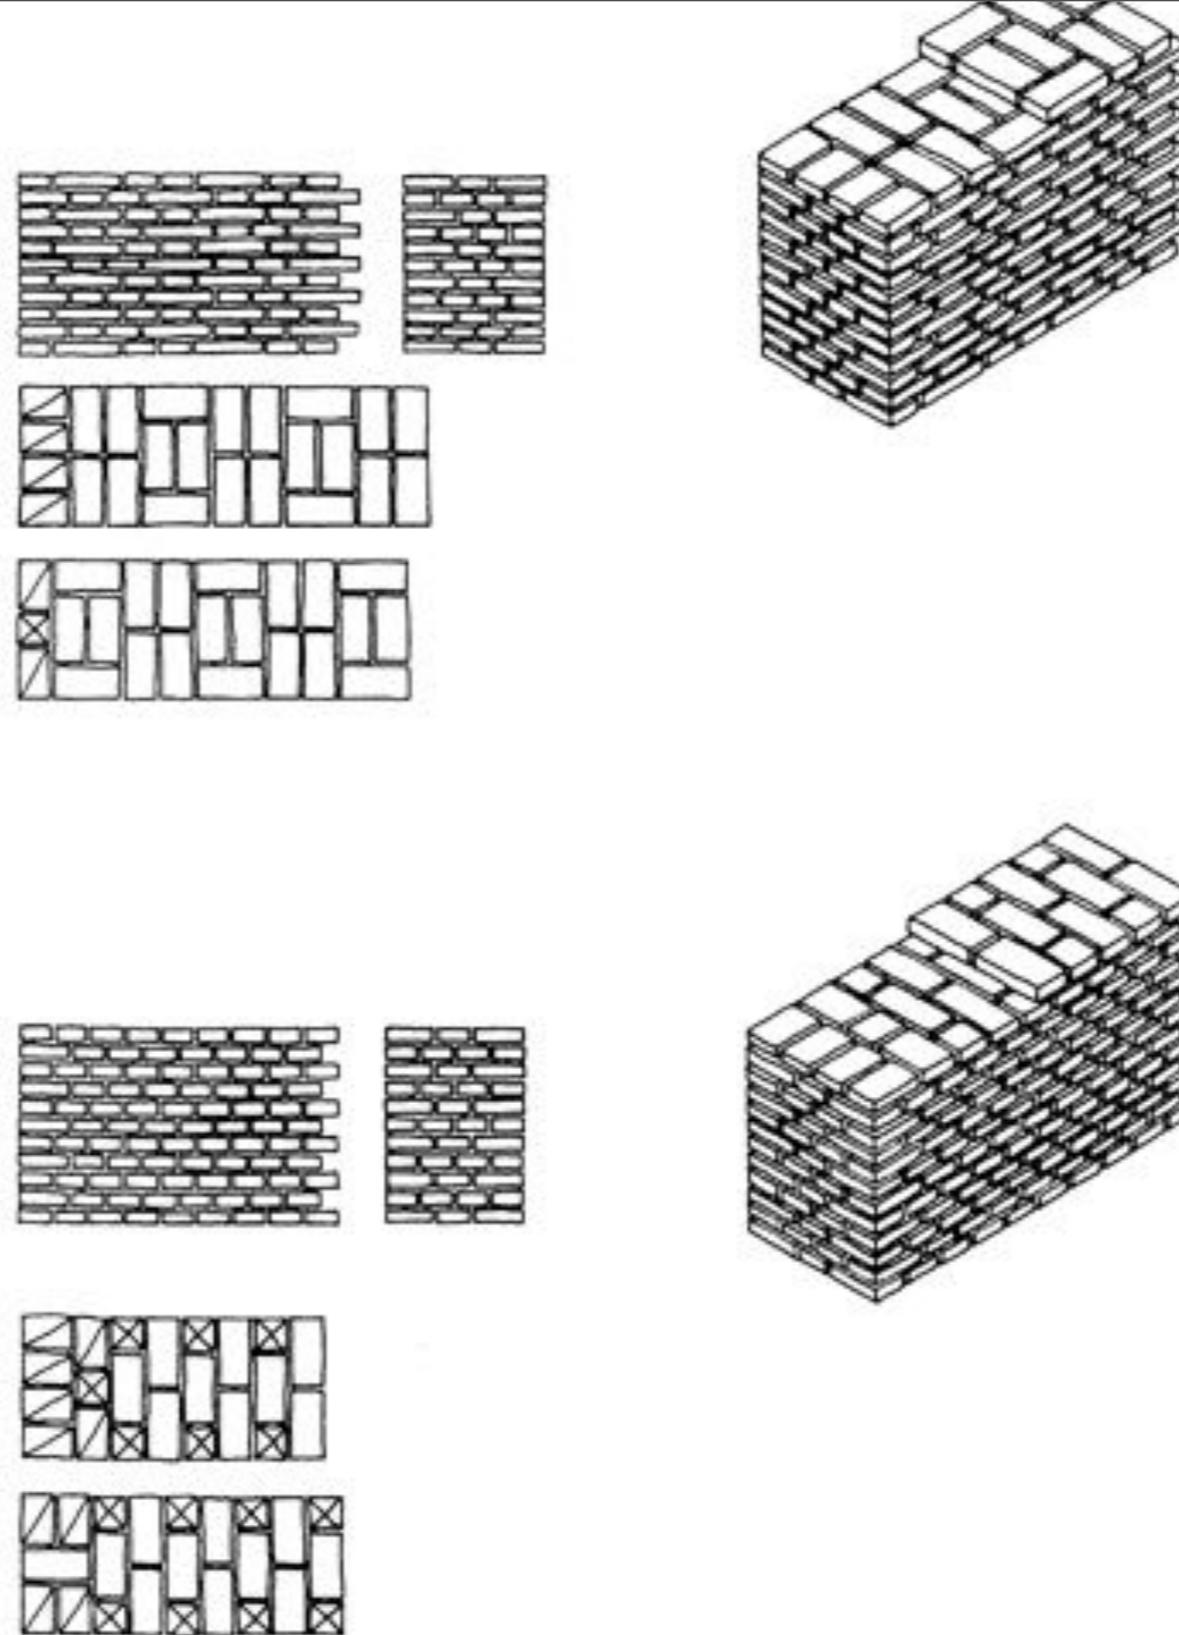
Schema in alto: muro a quattro teste: concatenamento gotico (variante). Veduta assonometrica, prospetto, sezione e pianta dei corsi di mattoni; schema in basso: muro a quattro teste: concatenamento in chiave. Veduta assonometrica, prospetto, sezione e pianta dei corsi di mattoni
